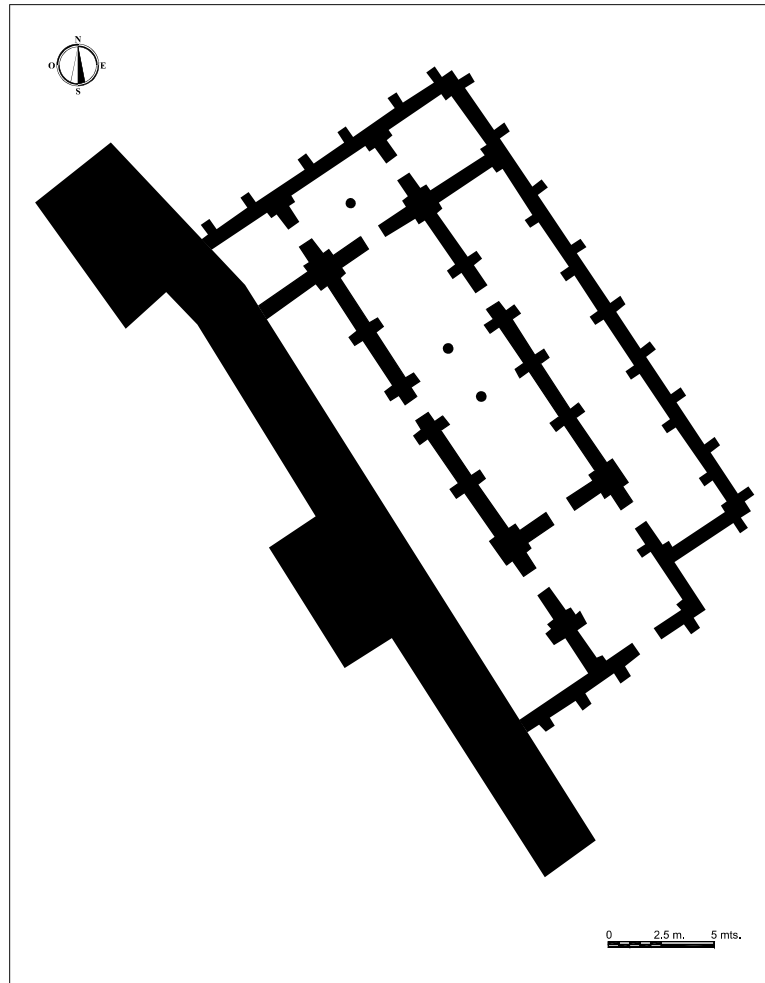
Planimetría de un edificio emiral excavado en el Área Arqueológica de Morería.
